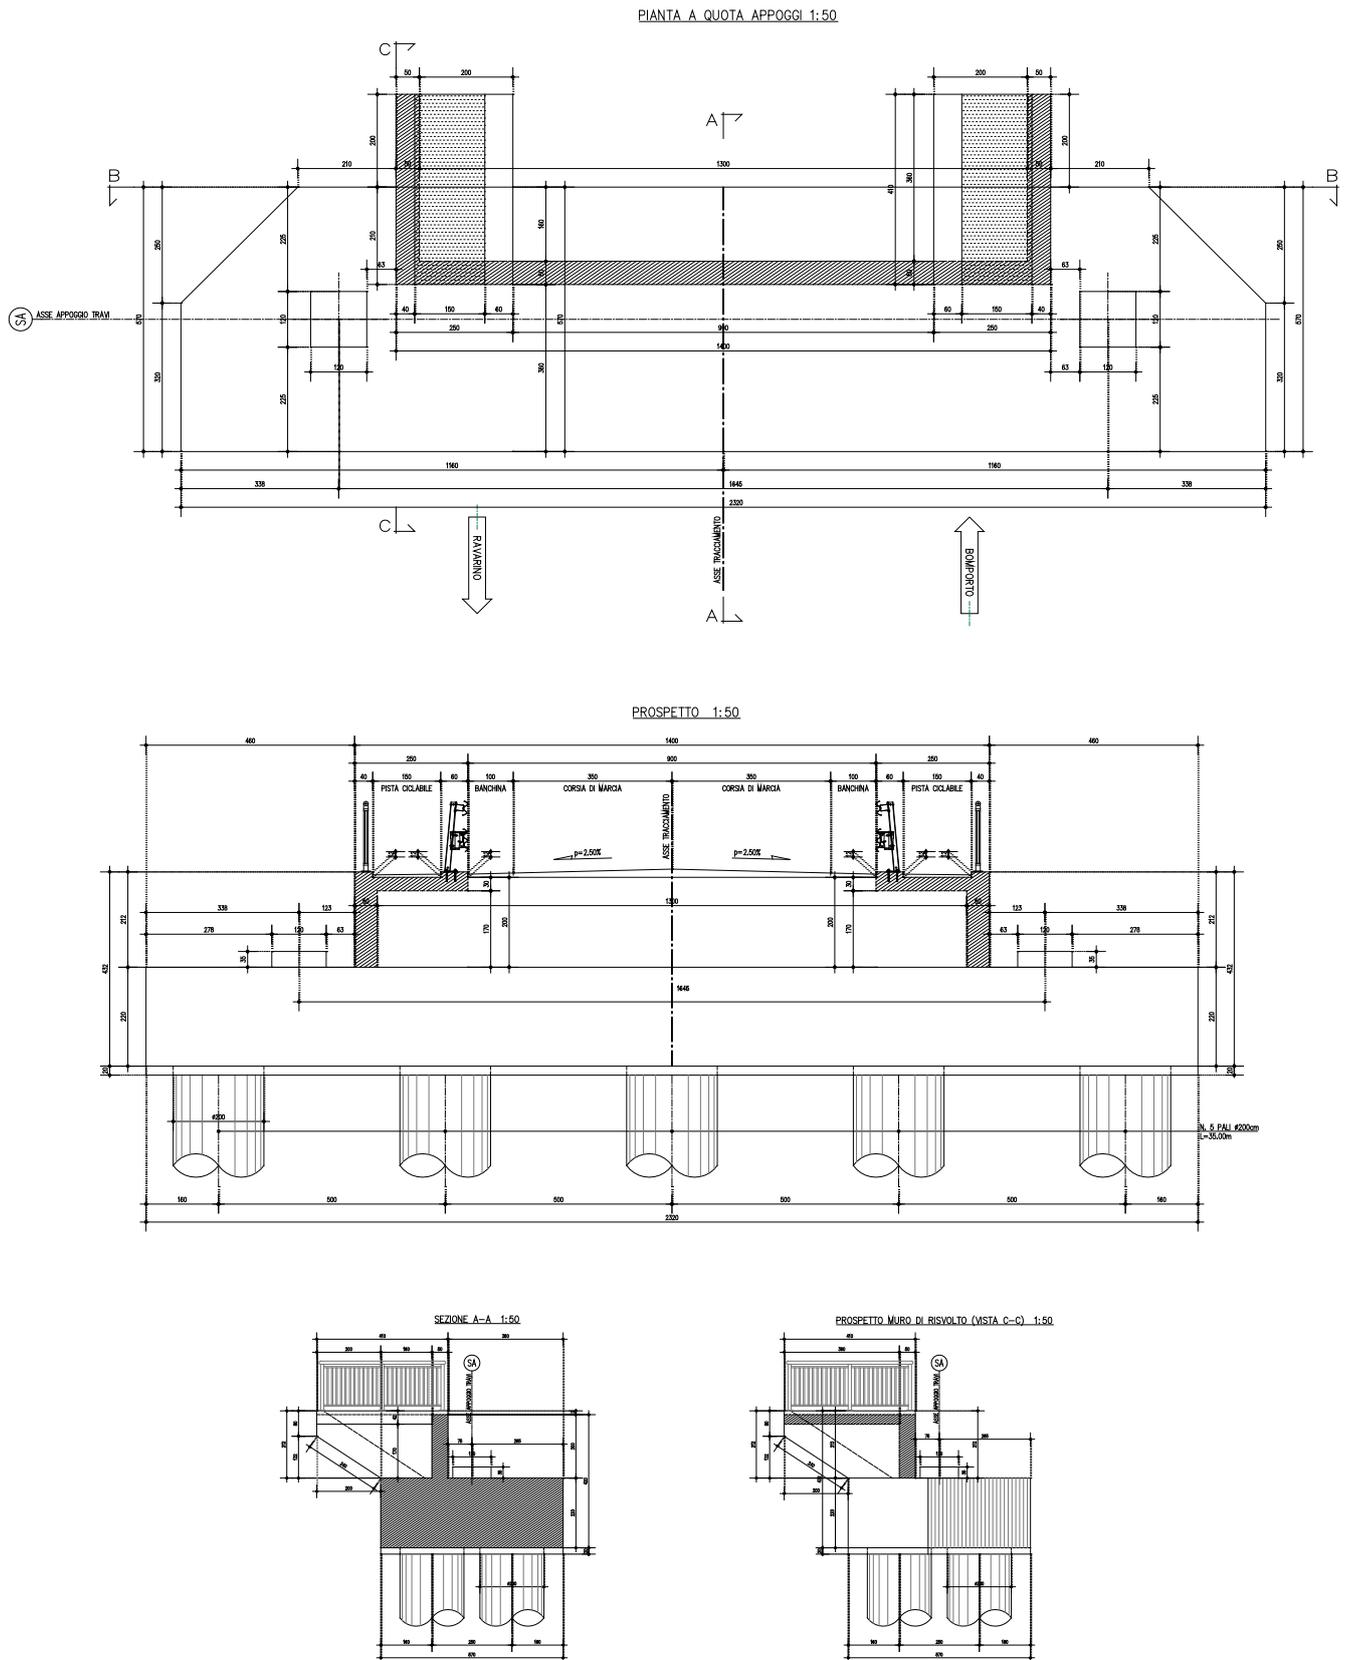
Spalla SA – Pianta, Prospetto, Sezione
